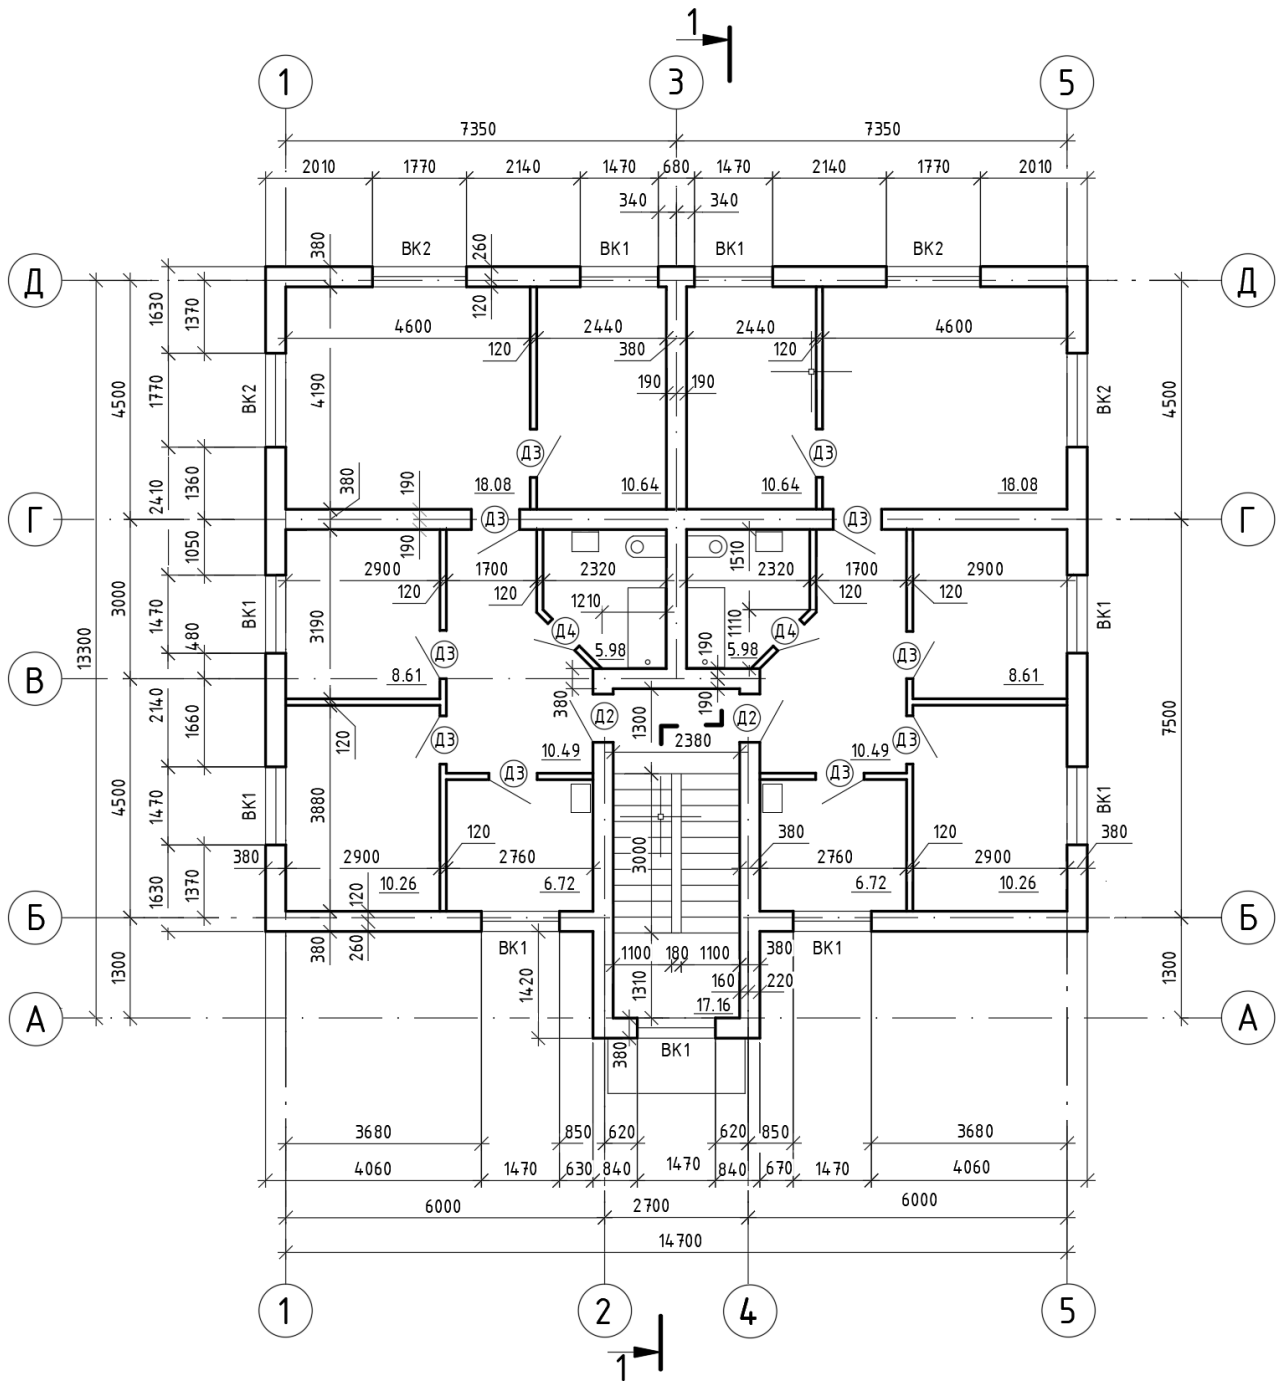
План першого поверху будинку з нанесенням отворів, сантехнічного устаткування і необхідних розмірів (фрагменти плану)
